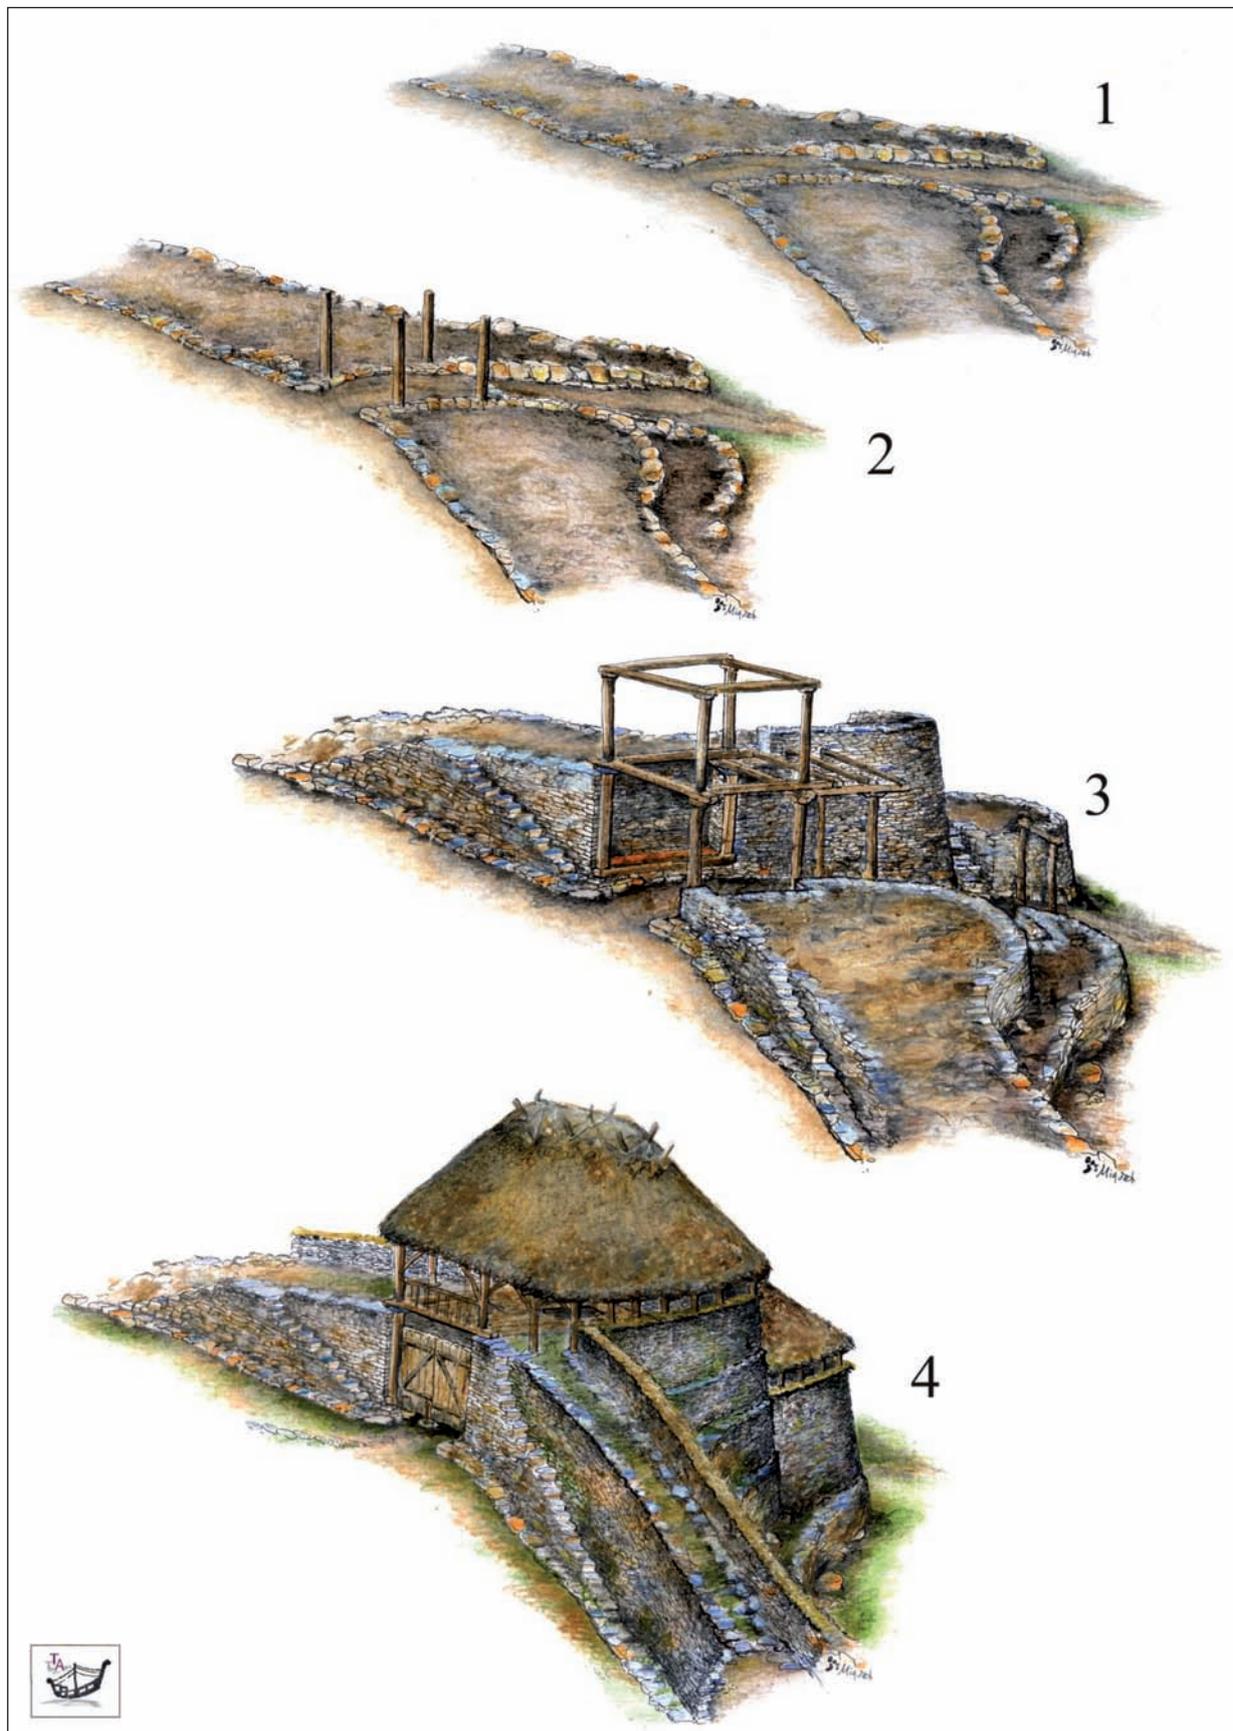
Reconstrucción de la entrada desde el interior en 4 fases: 1 cimentación, 2 Pies derechos, 3 Armadura de madera, 4 Acabado de cubierta
